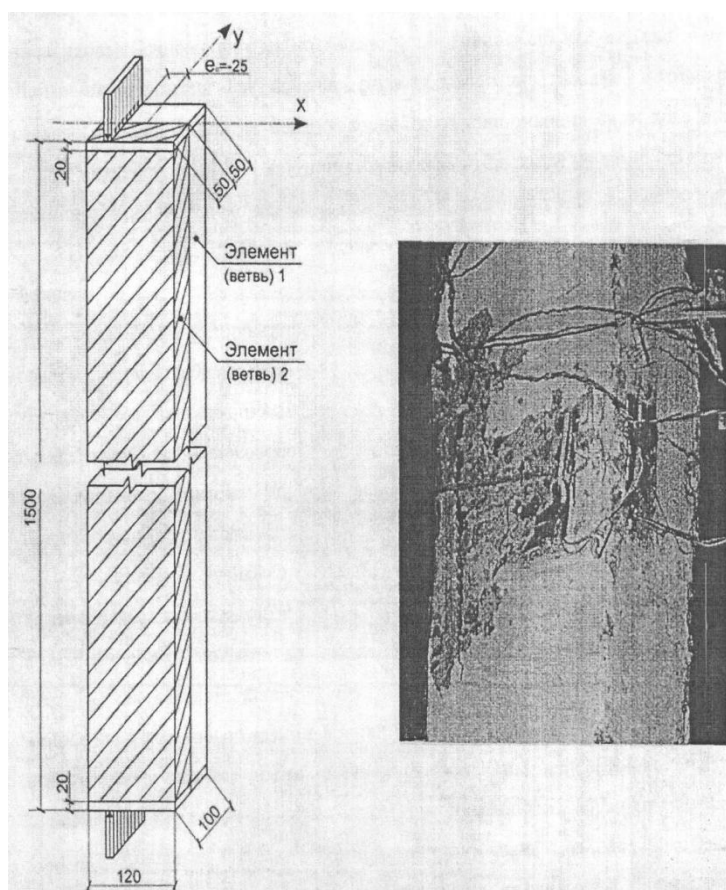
Схема испытаний опытных колонн серии К-II на внецентренное сжатие и фотография разрушения колонны
